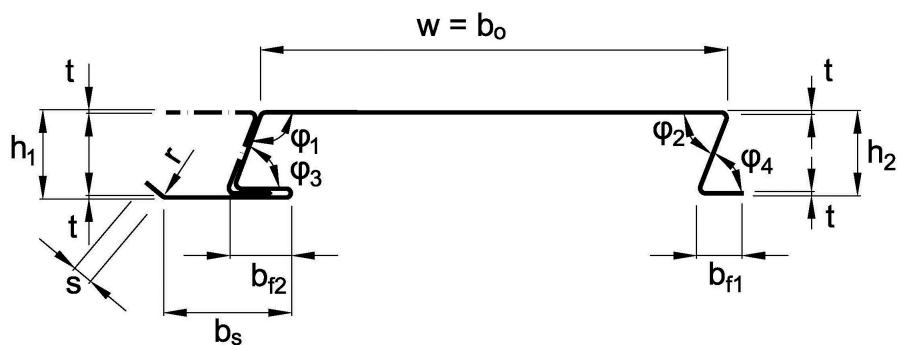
Section transversale des profilés de bardage / façade sans joint creux
